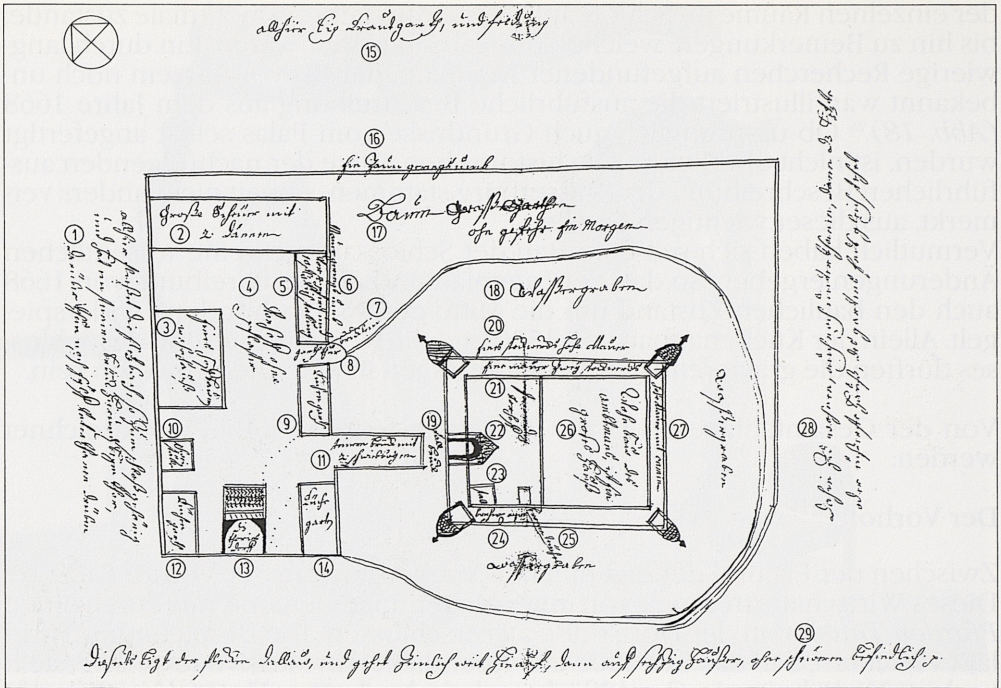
Schloß Dallau. Lageplan aus dem Jahre 1668.
